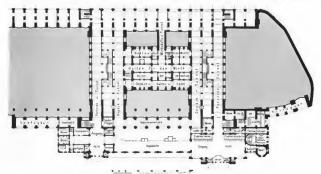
Grundrife des Untergeschesses. Empfangsgebäude auf dem Hauptbahnhofe in Köln.
